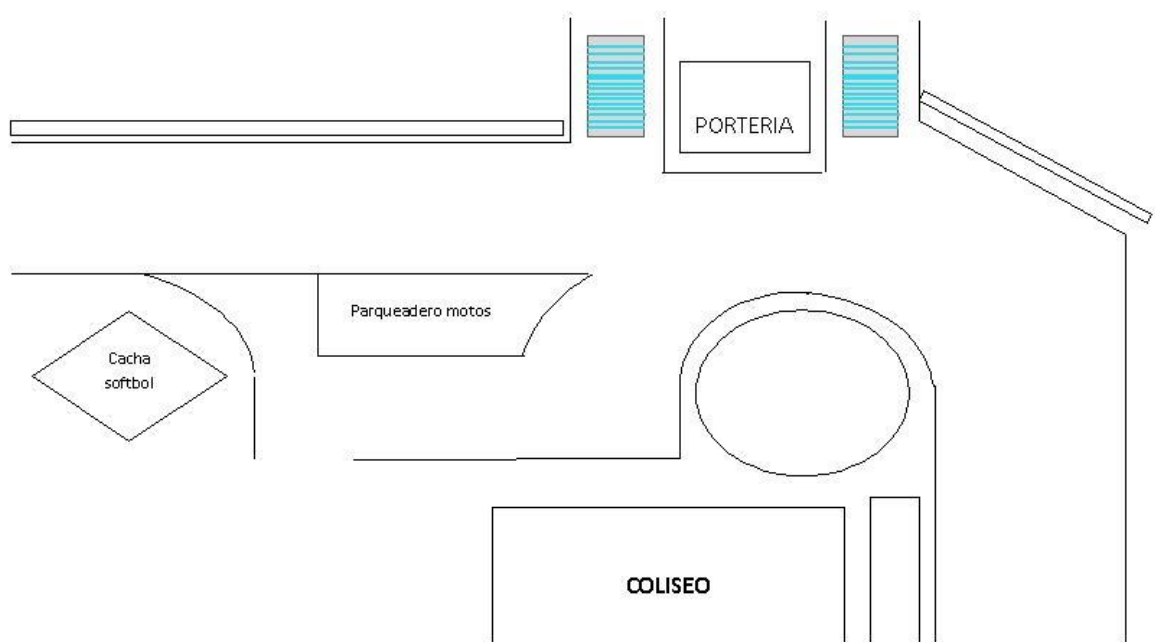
Entrada carrera 30 con el dispositivo de Electro Kinetic Road Ramp instalado.
